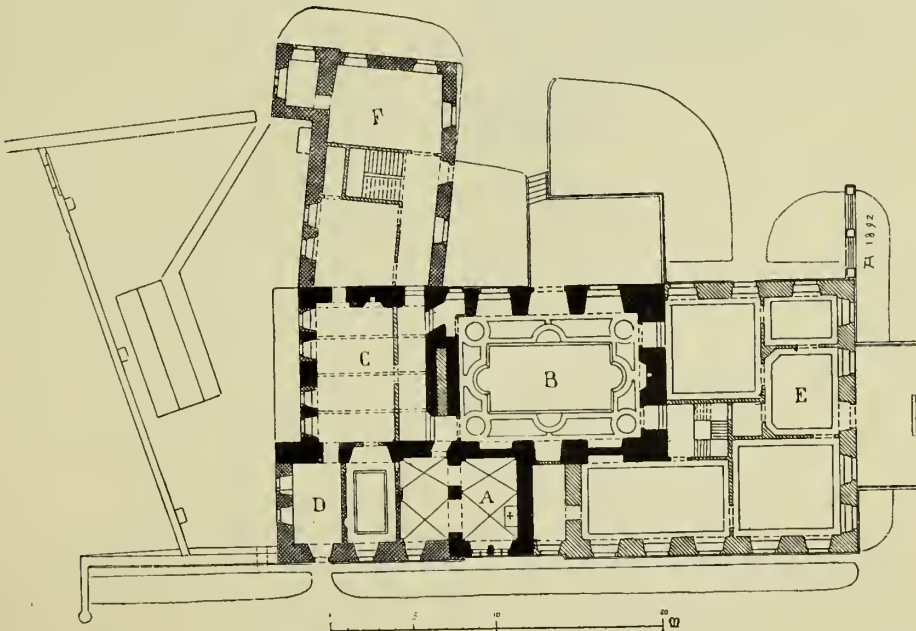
Schellenberg. Grundriss des Schlosses.
